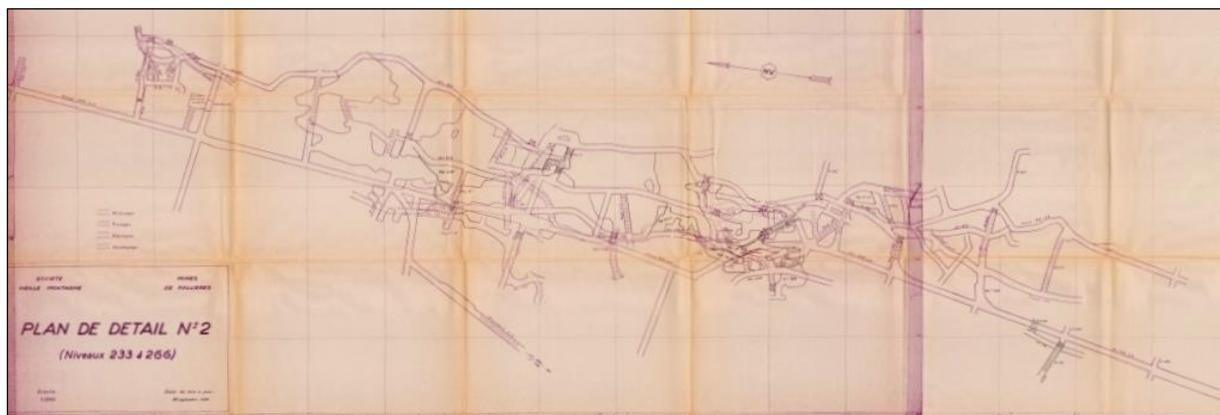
Mines de Pallières, plan de détail n° 2 (niveaux 233 à 266) (1956)
